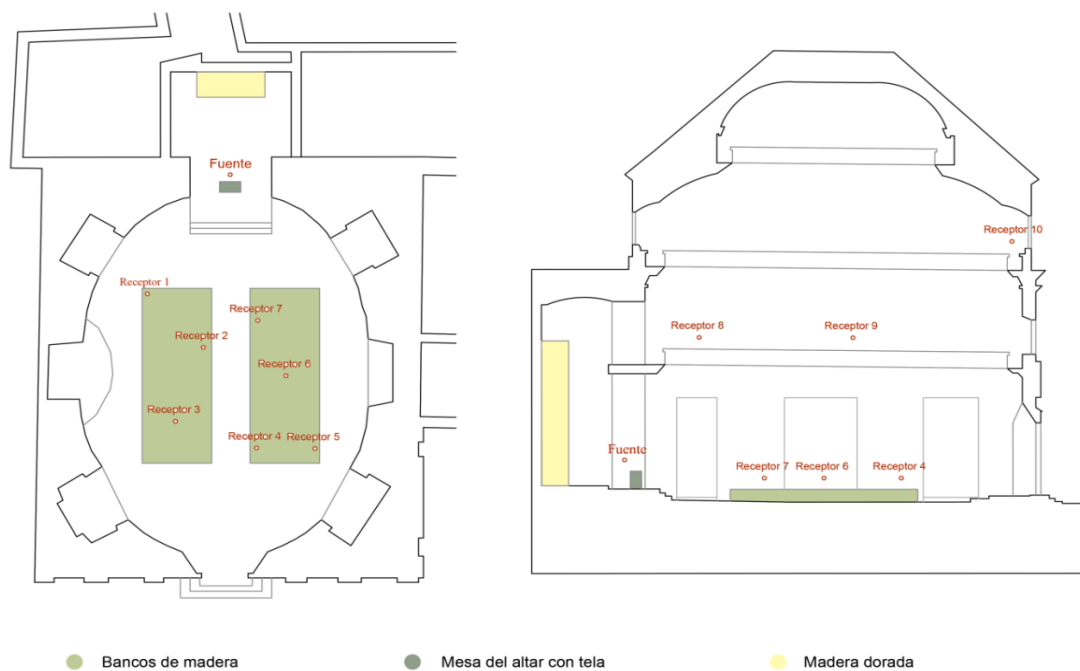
, posición de receptores y fuente sonora en los modelos M0 y M1, en planta y sección
